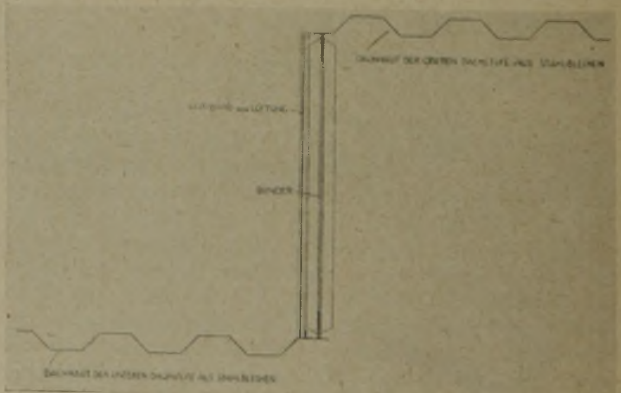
Leichtbauhalle, System Krupp, mit Stahlblechdachhaut
